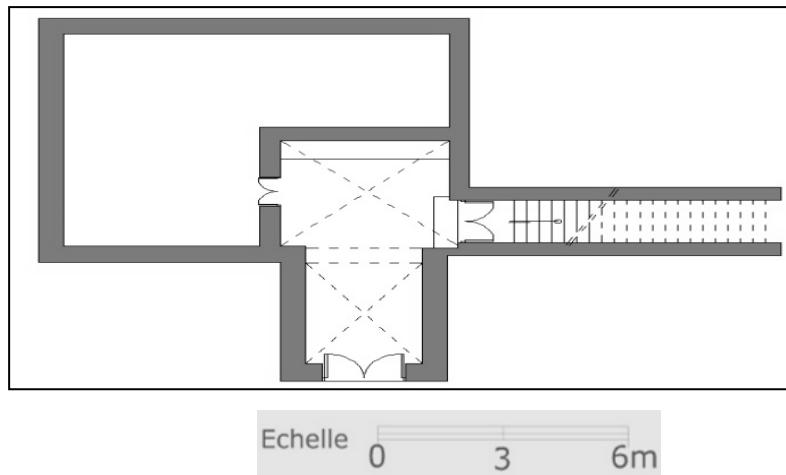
Plan du rez-de-chaussée (hall d'entrée et l'escalier principal de distribution)
